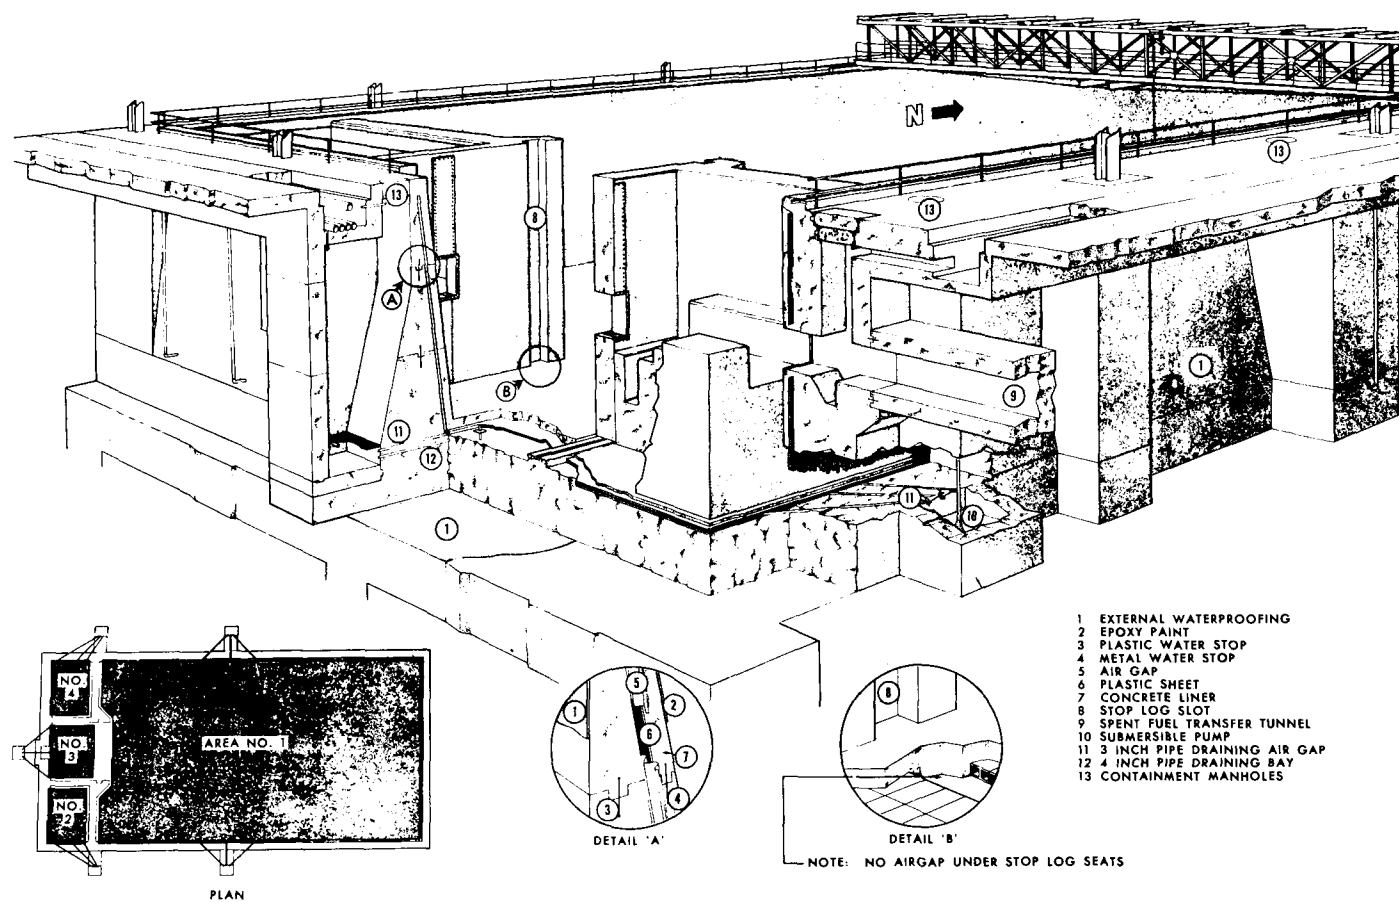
SISTEMA DE ALMACENAJE DE COMBUSTIBLE QUEMADO
